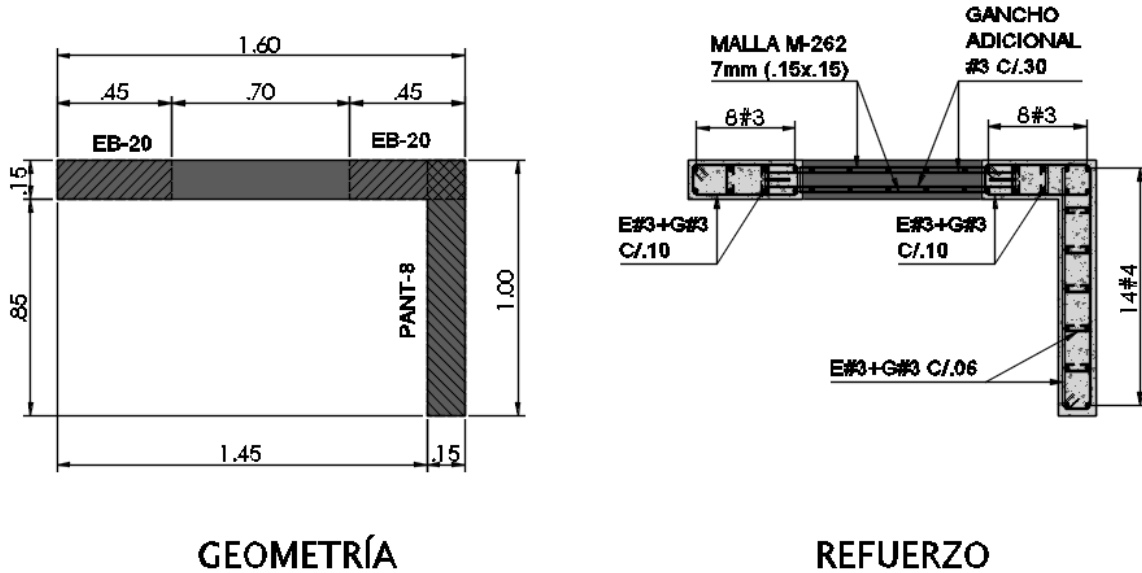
Esquema geométrico y de refuerzo, Muro M-7. Fuente: Elaboración propia.
